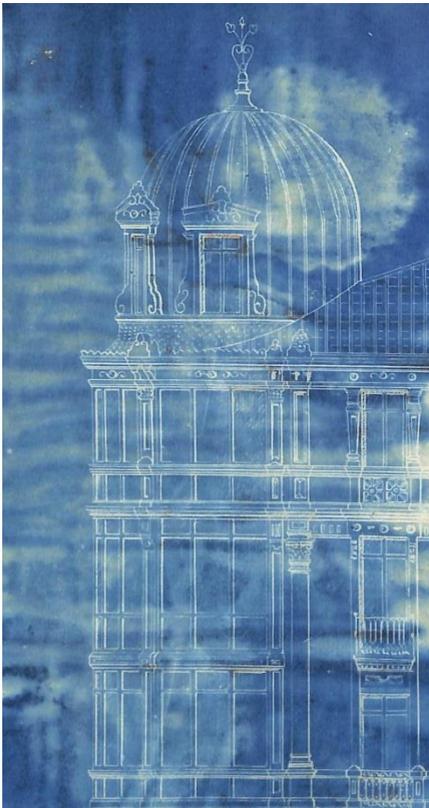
Detalle del alzado de la fachada de la casa de Félix Murga y Félix Arana. Julio Saracíbar. 1885. Bilbao
